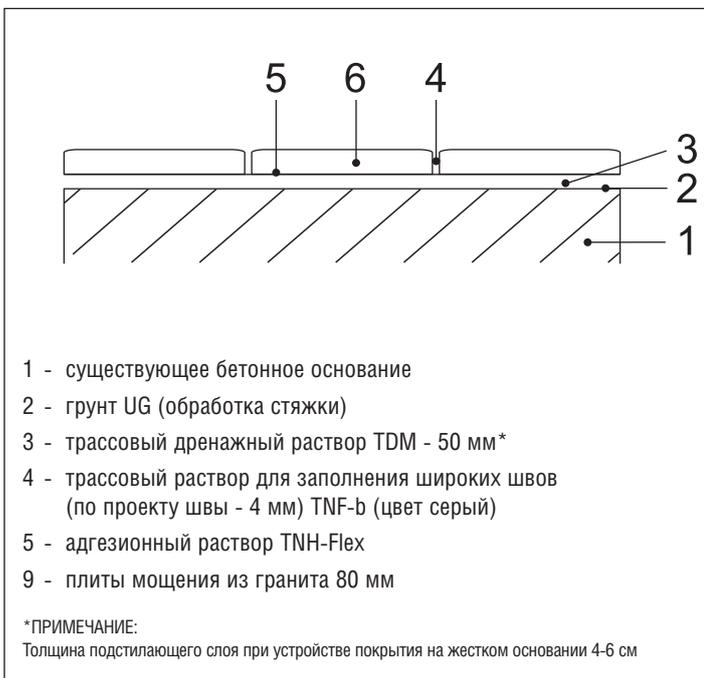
Поперечный разрез дорожного покрытия с использованием растворов на основе вяжущих.
